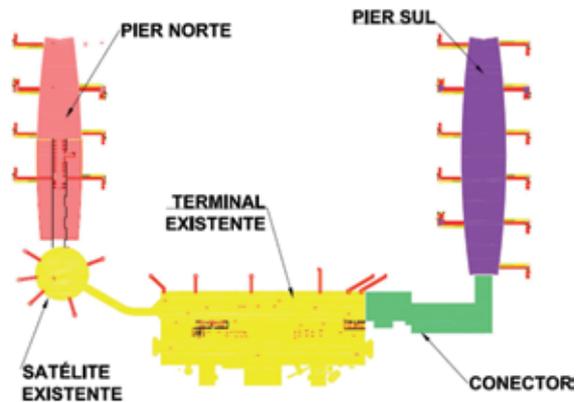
Primeira fase da obra executada no Conector e pier Sul. Segunda fase pier Norte
